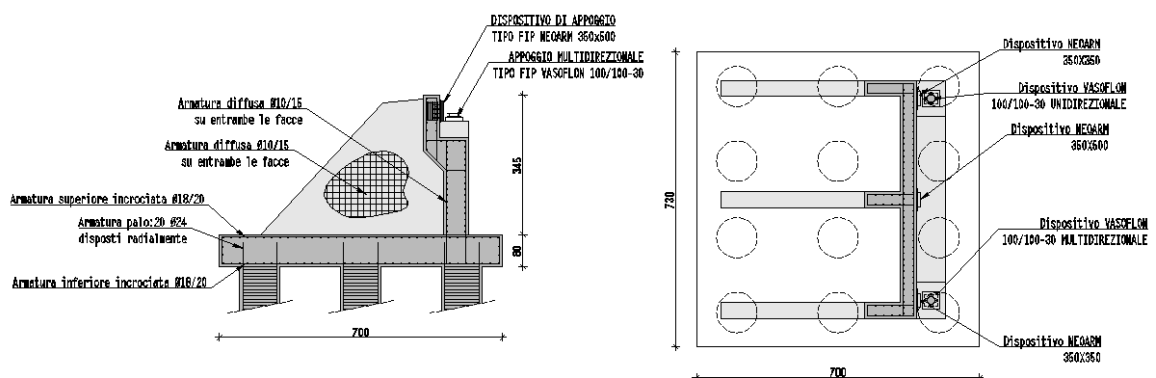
Spalla sinistra (quote in cm)
